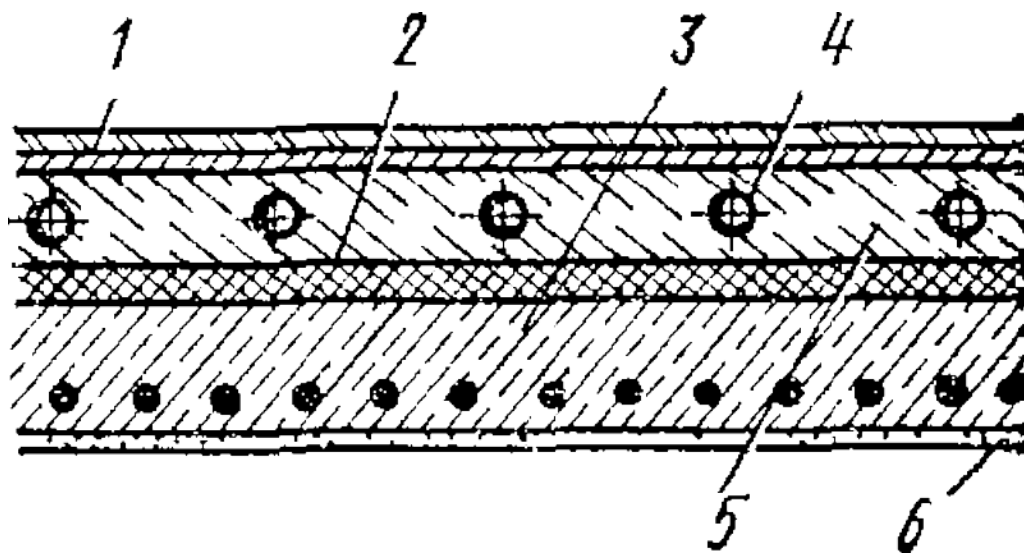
Напольная бетонная отопительная панель: 1 – покрытие пола, 2 – теплоизоляционный материал, 3 – железобетонное несущее перекрытие, 4 – греющая труба, 5 – бетонная панель, 6 – штукатурка
